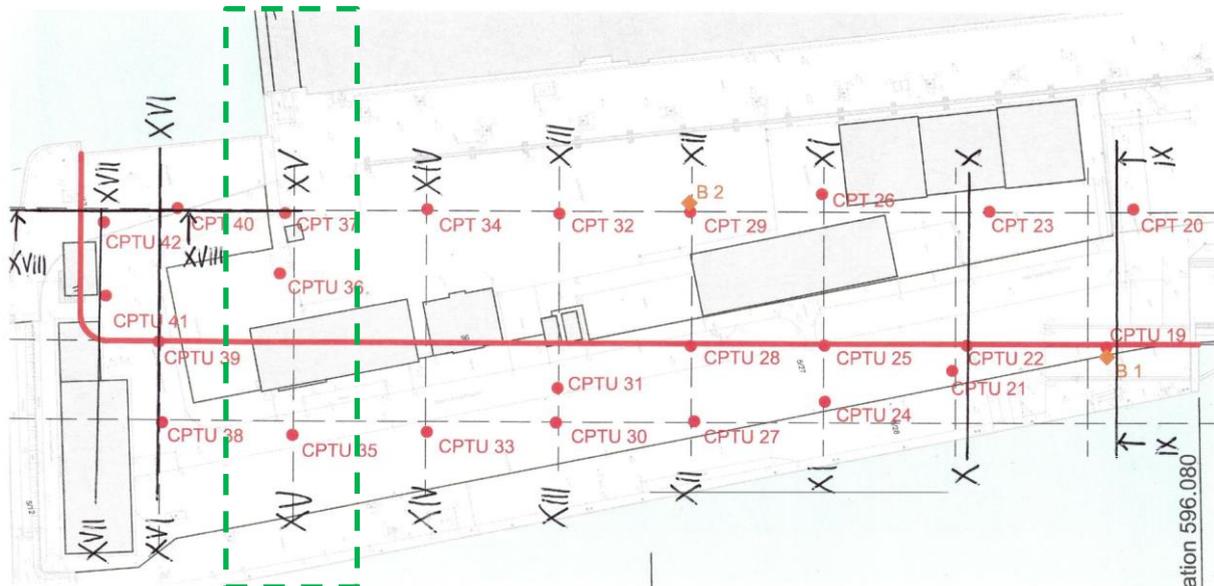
Bemessungsprofil XV - Lage [U1]
